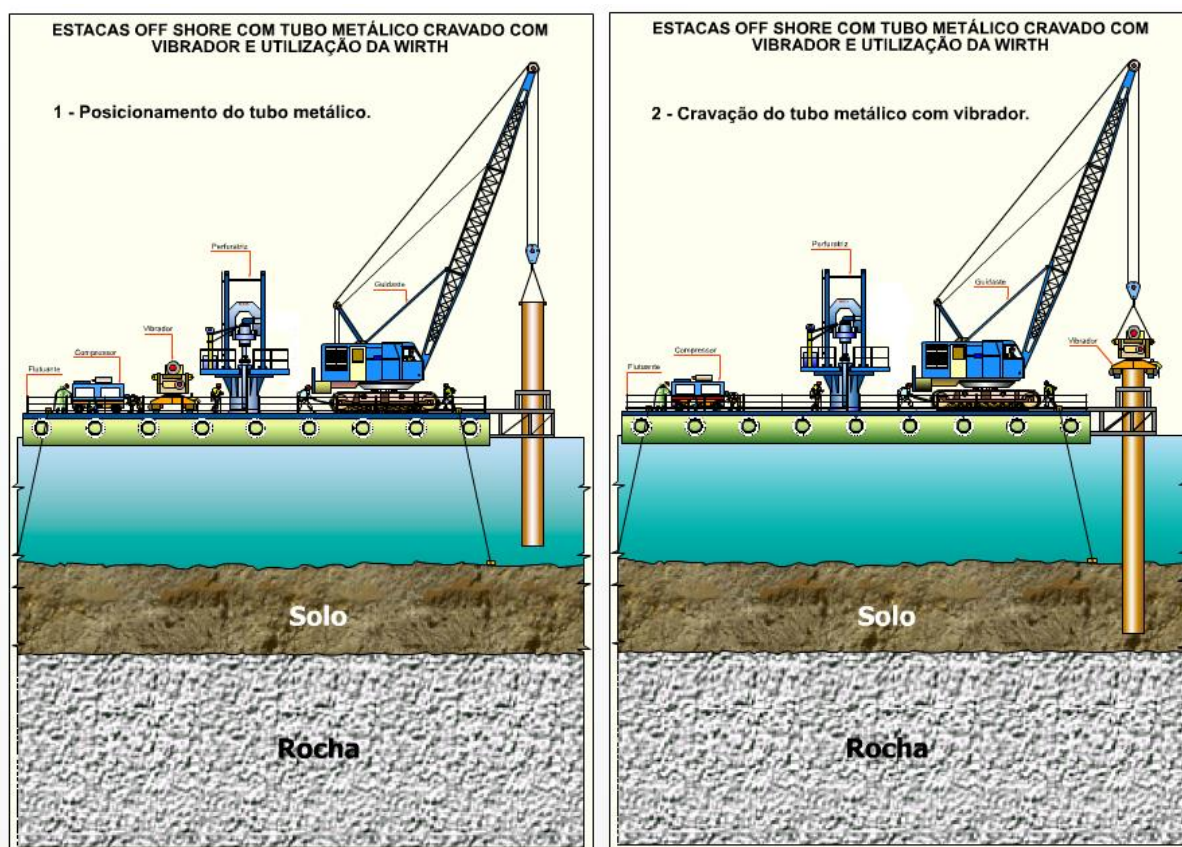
Sequência do método construtivo de fundações com estacas escavadas tipo Wirth.
